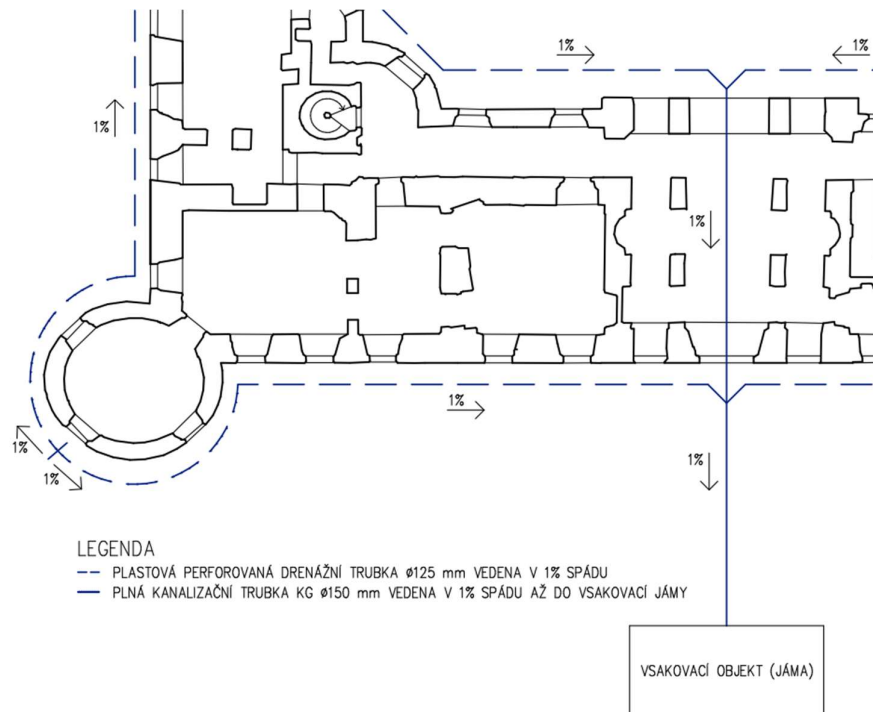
Detail D1 – Drenážní systém vedený podél základových konstrukcí
